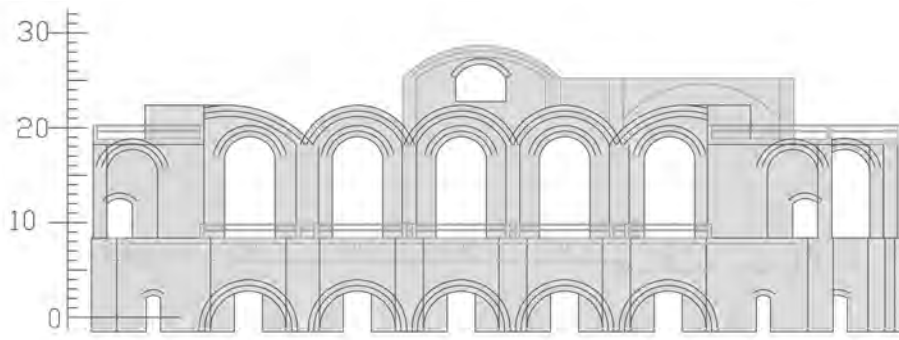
Rekonstruktionsvorschlag Südfassade.
